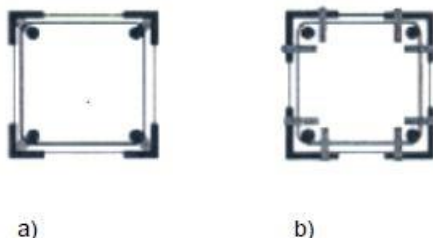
Ligação entre o elemento reforçado e as cantoneiras complementada com a) soldadura às armaduras existentes ou b) buchas metálicas, [26].
